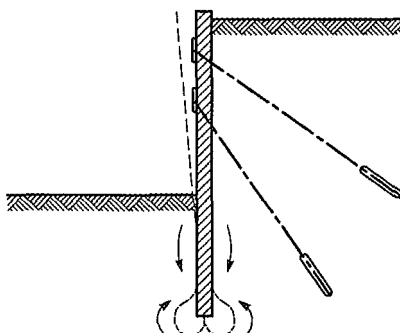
Beispiel für das Versagen einer bodengestützten Wand durch Vertikalbewegung
